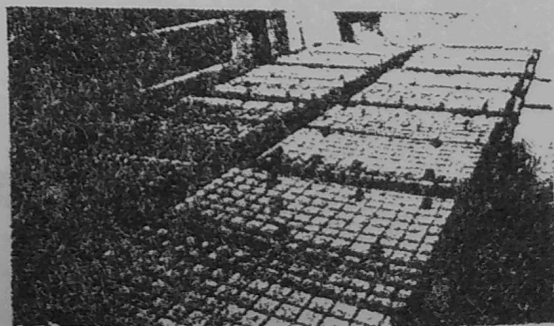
Устройство поперечных армокаркасов перед бетонированием
